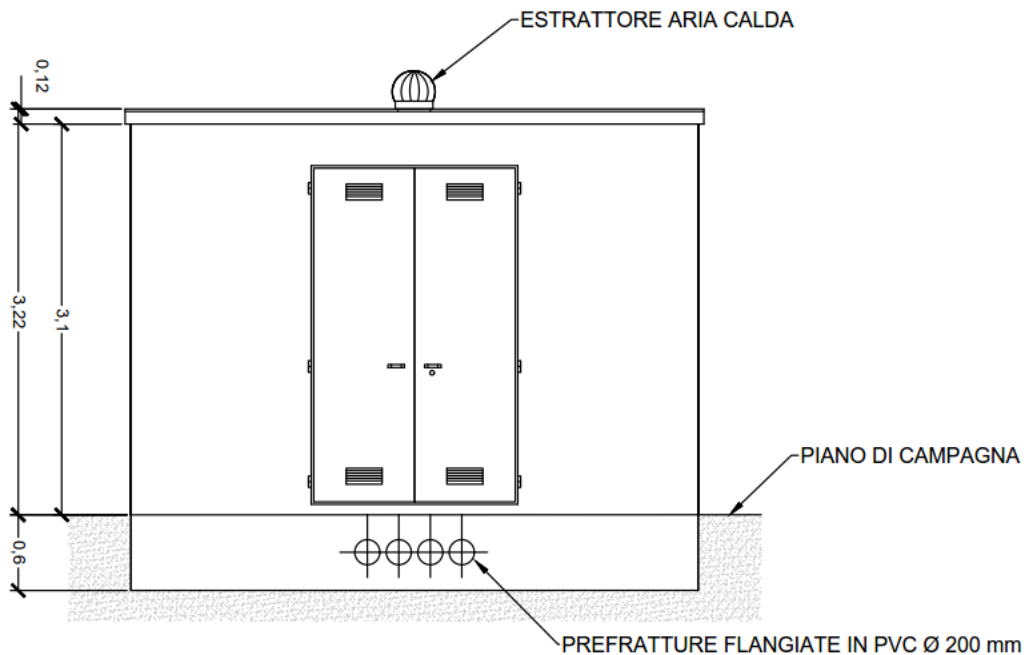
prospetto delle cabine di raccolta installate in campo
